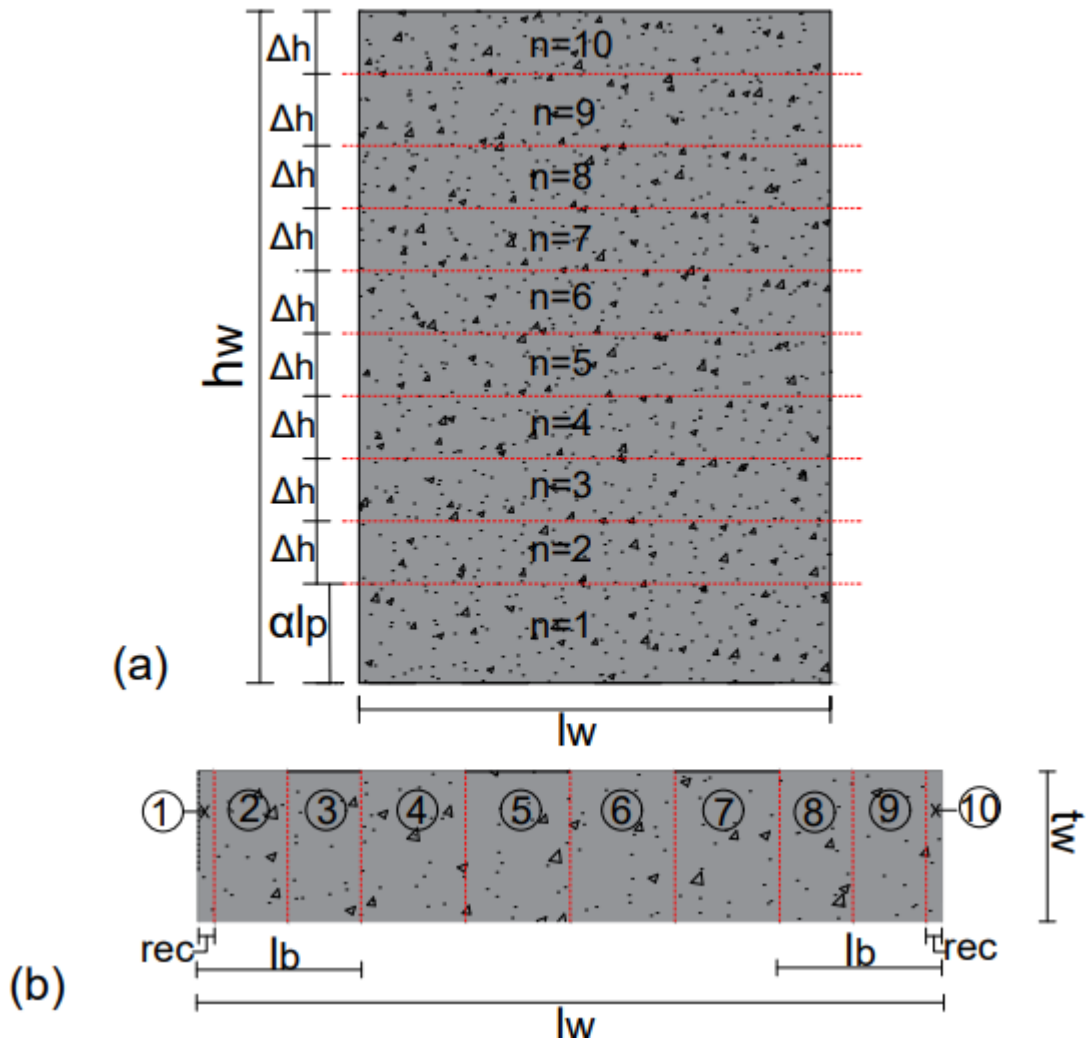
Discretización general de la sección. Elevación con 10 elementos (a); Transversal con 10 paneles (b).
